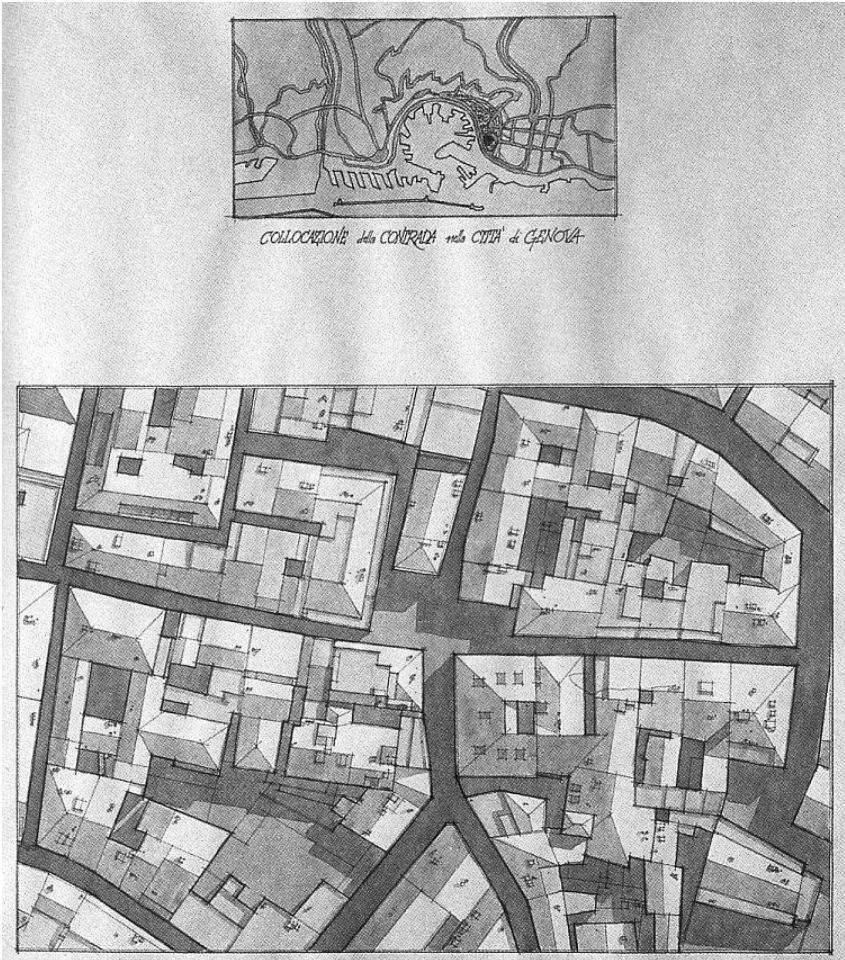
Planimetria della zona in cui si trova la Contrada dei Salvago.
